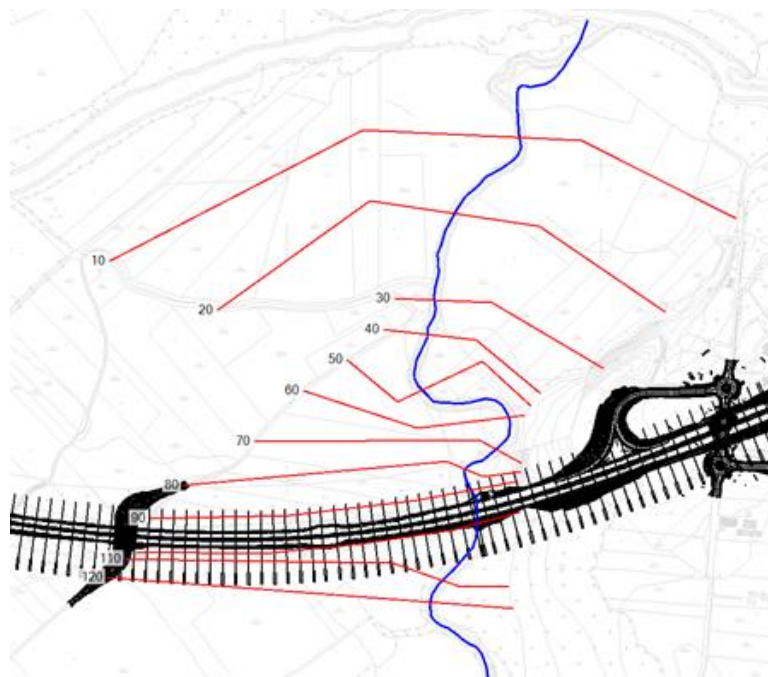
Inquadramento planimetrico della nuova opera VI12: sezioni modellate (planimetria modello idraulico)
